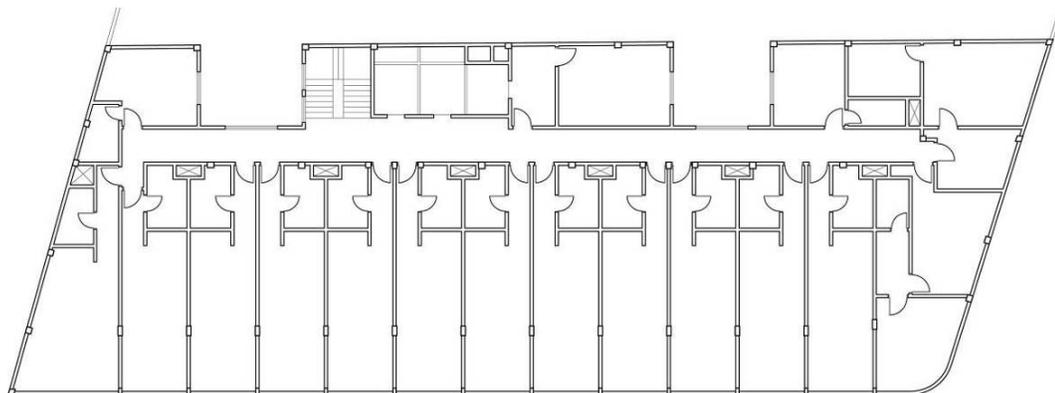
2<sup>o</sup>-7<sup>o</sup> Pavimento Tipo
